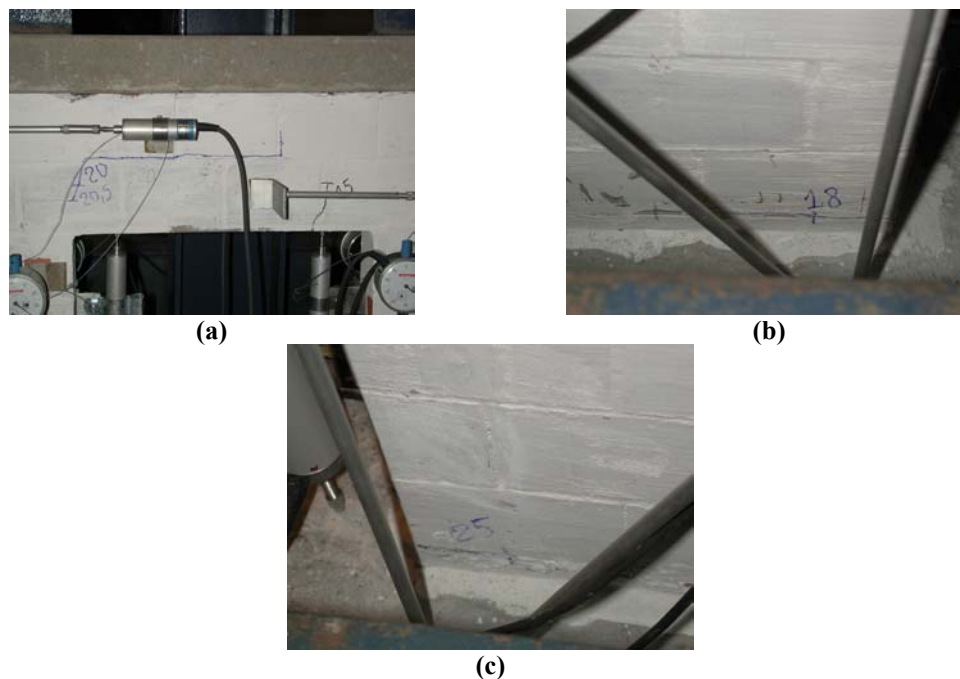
Primeiras fissuras visíveis – modelo PPSG1: (a) Lintel; (b) Base da parede P2; e (c) Base da parede P1.
